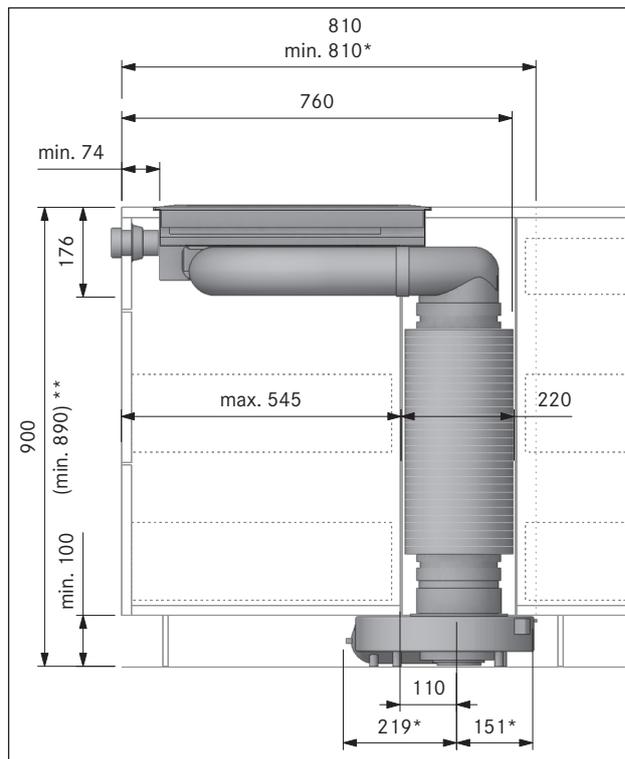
Dimensioni di montaggio apparecchi PKA3/PKA3AB con silenziatore rotondo USDR50 per il montaggio standard
